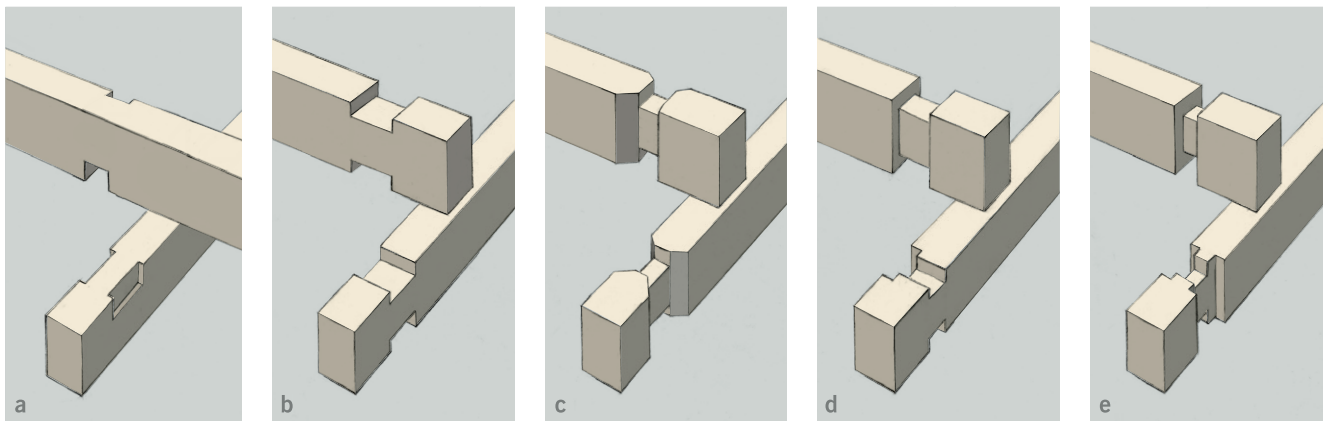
Die Kammsassen für die Verkämmung der Balkenlagen sind unterschiedlich gestaltet: a) Kammsasse wie sie ausschliesslich bei vor 1600 errichteten Blockbauten anzutreffen ist; b) einfachste Ausführung einer Kammsasse; c) einfache Kammsasse mit abgeschägten vertikalen Kanten; d) einseitig, gestufte Kammsasse; e) aufwendige gestufte Kammsasse.
